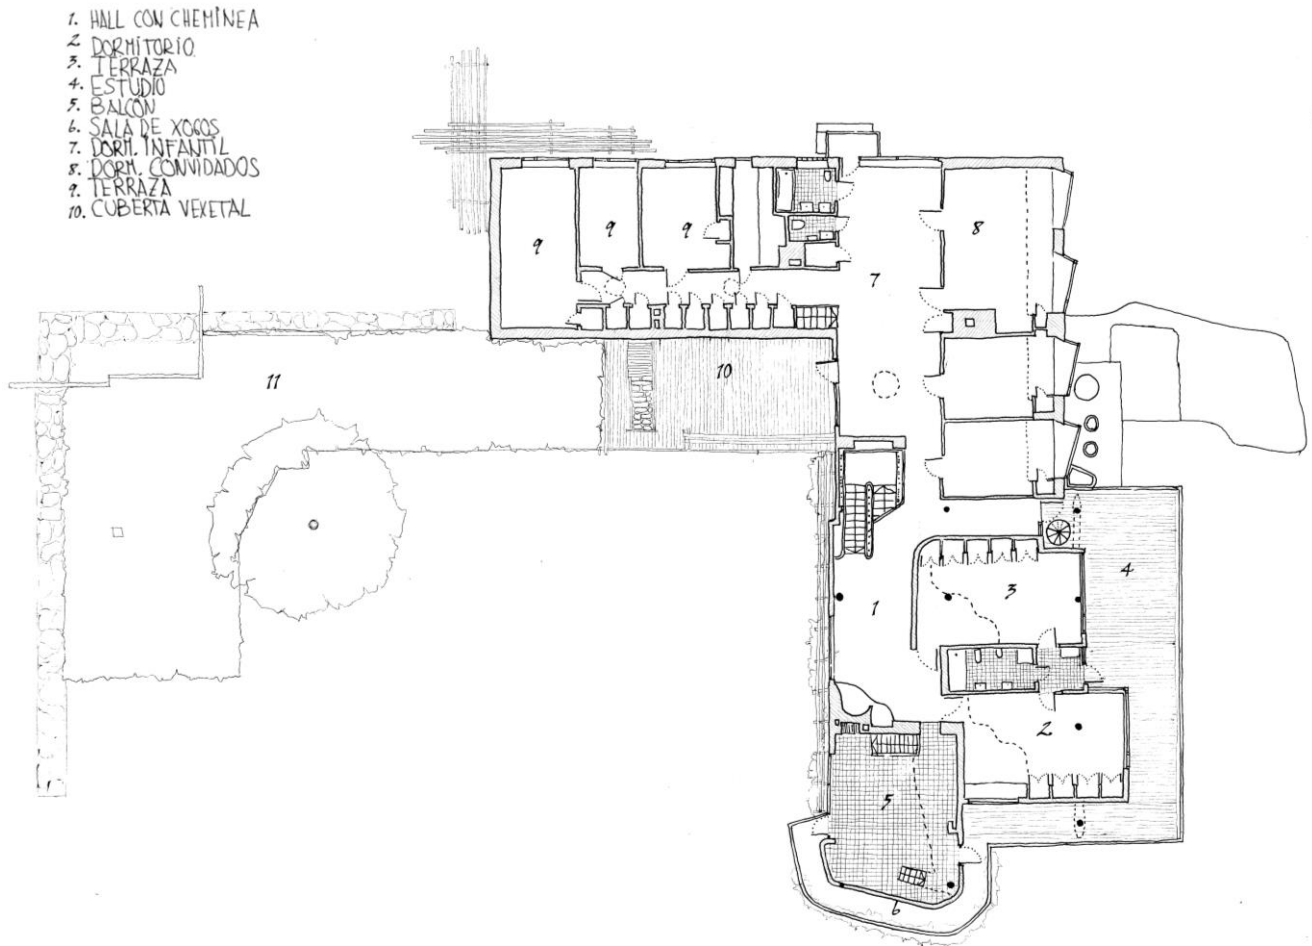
Plano planta alta Vila Mairea. Versión construída _ Elaboración propia
